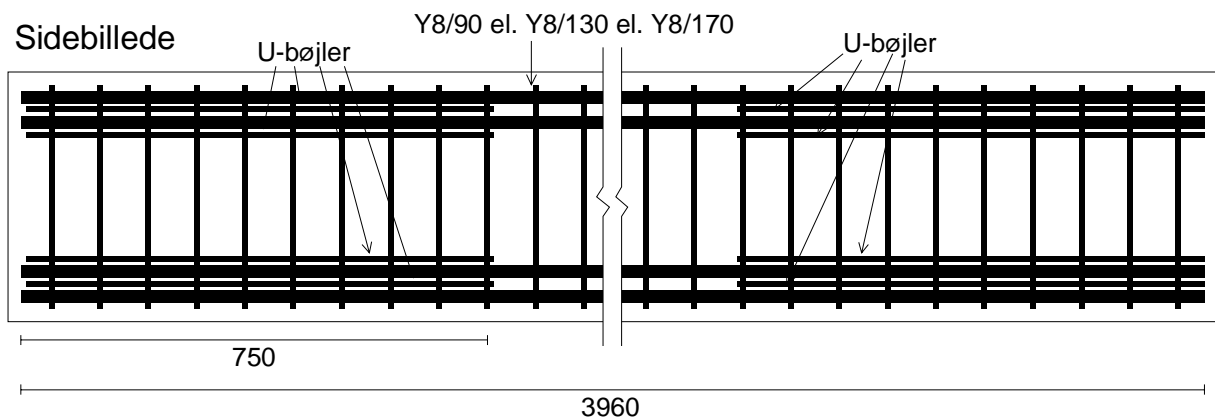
Prøvemner med armeringsarrangement til aggressive betoner. Alle mål i mm.
